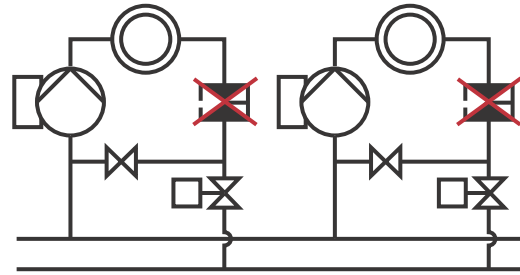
Mindre behov for en pumpeindreguleringsventil
